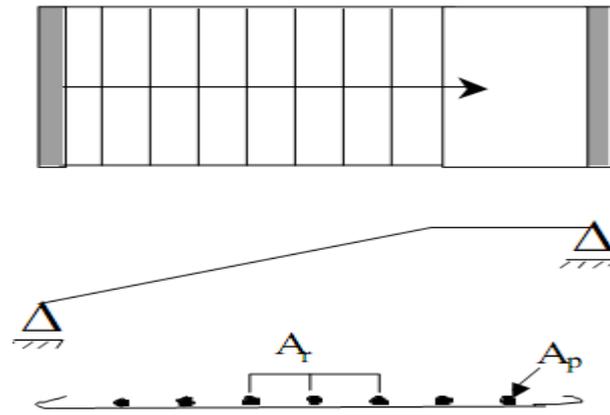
Système statique (Escalier à paillasse à un seul palier).
